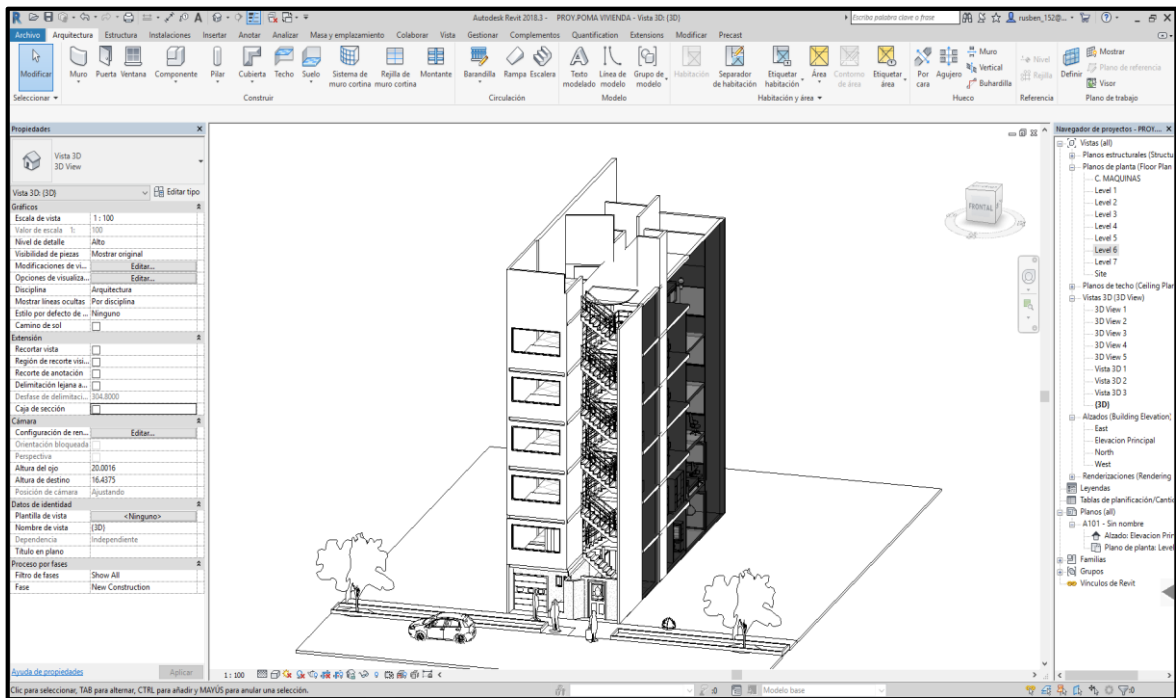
Modelado arquitectónico del edificio Revit - 2018. Vista isométrica. Fuente propia.
